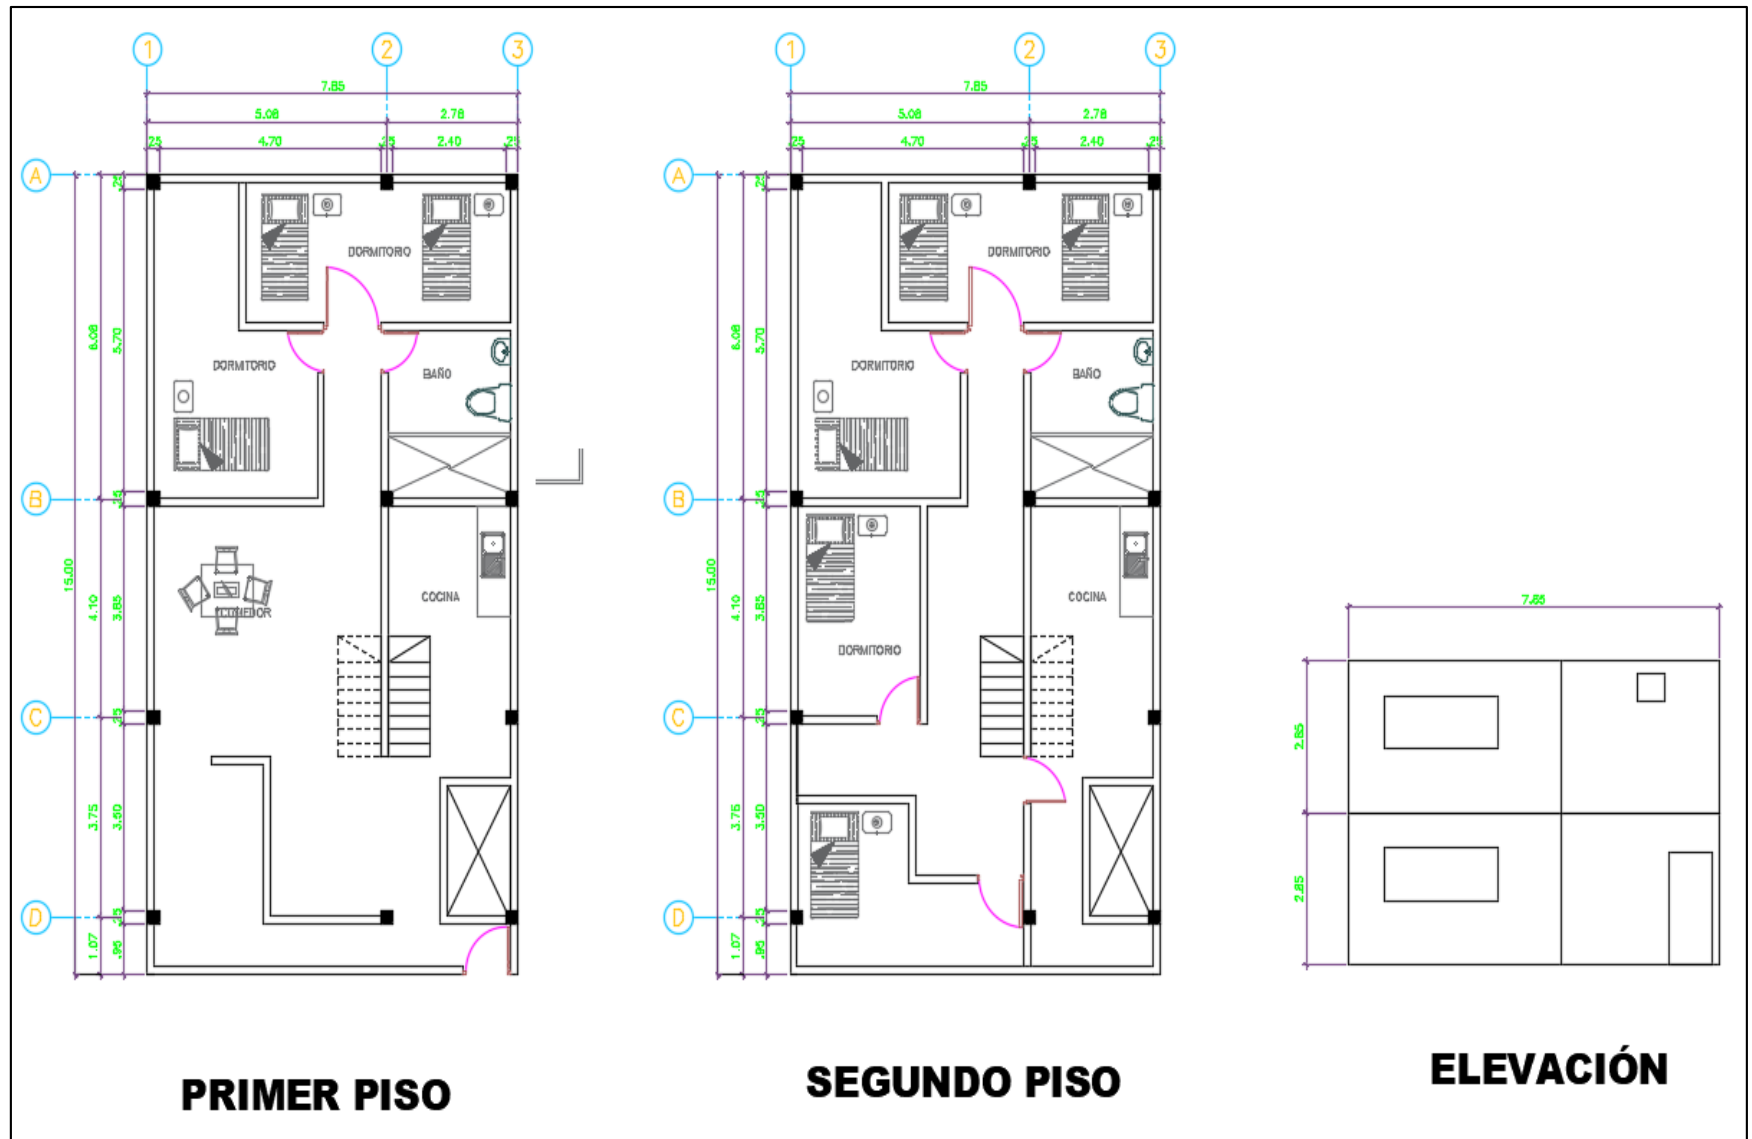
Planos en planta y elevación de la vivienda ubicado en la Avenida El Trabajo 342
